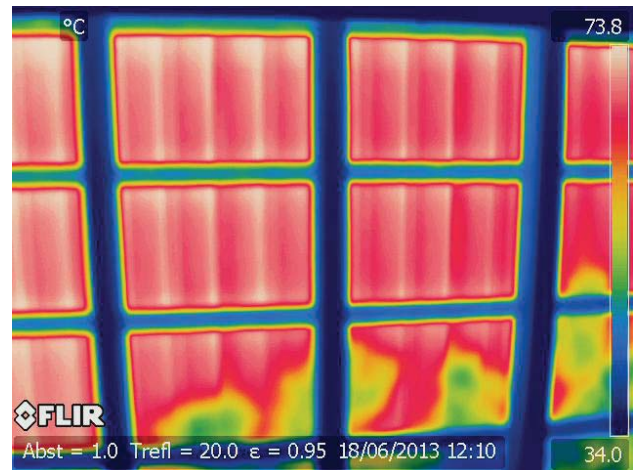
Wärmebildaufnahme einer ungedämmten grauen Dachkonstruktion, Quelle: ZENTNER 2013
